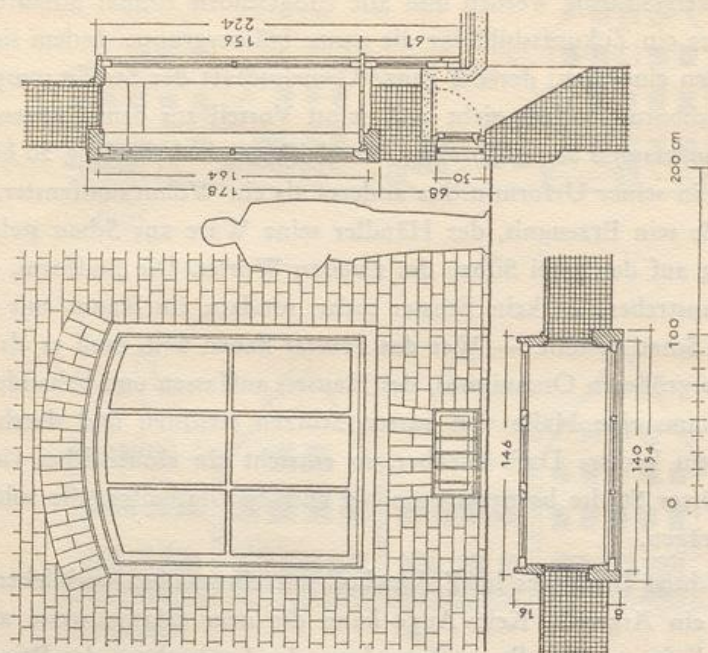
Schaufensteranlage, in Größe und Scheibenaufteilung dem zweiachsigen Hause angemessen
